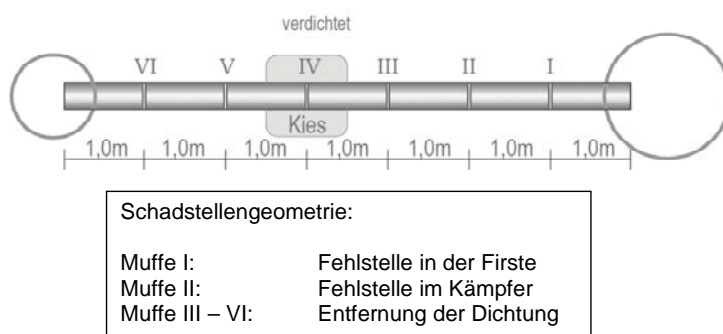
Sanierungsstrecke 1, Betonrohrhaltung
